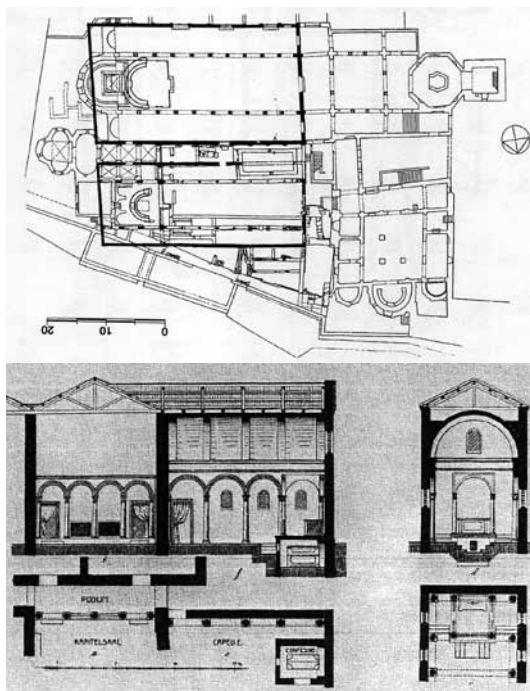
a) Planimetria dell'episcopio di Parenzo;
